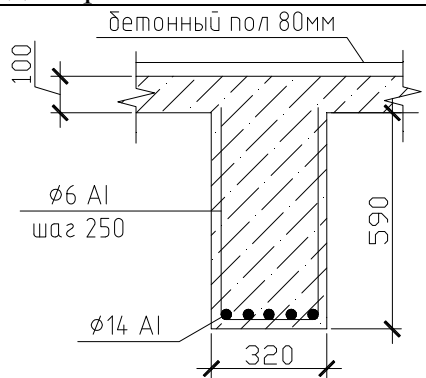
Главная балка ж/б перекрытия над вторым этажом в осях «8-11/Б-В»
